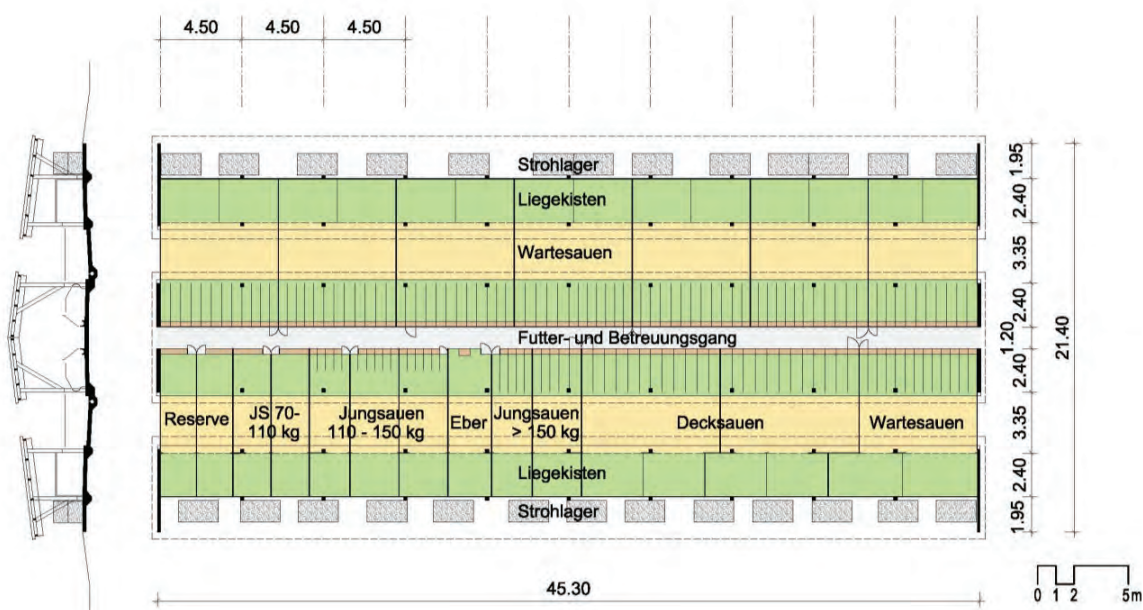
Grundriss und Schnitt des Deck-/Wartestalls MODELL I
